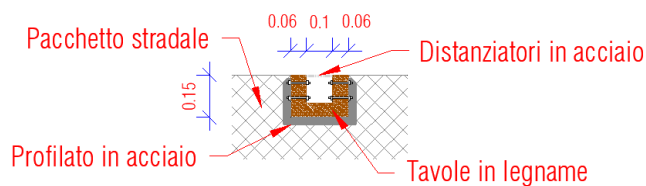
Estratto dalla tavola di progetto - Canaletta trasversale
